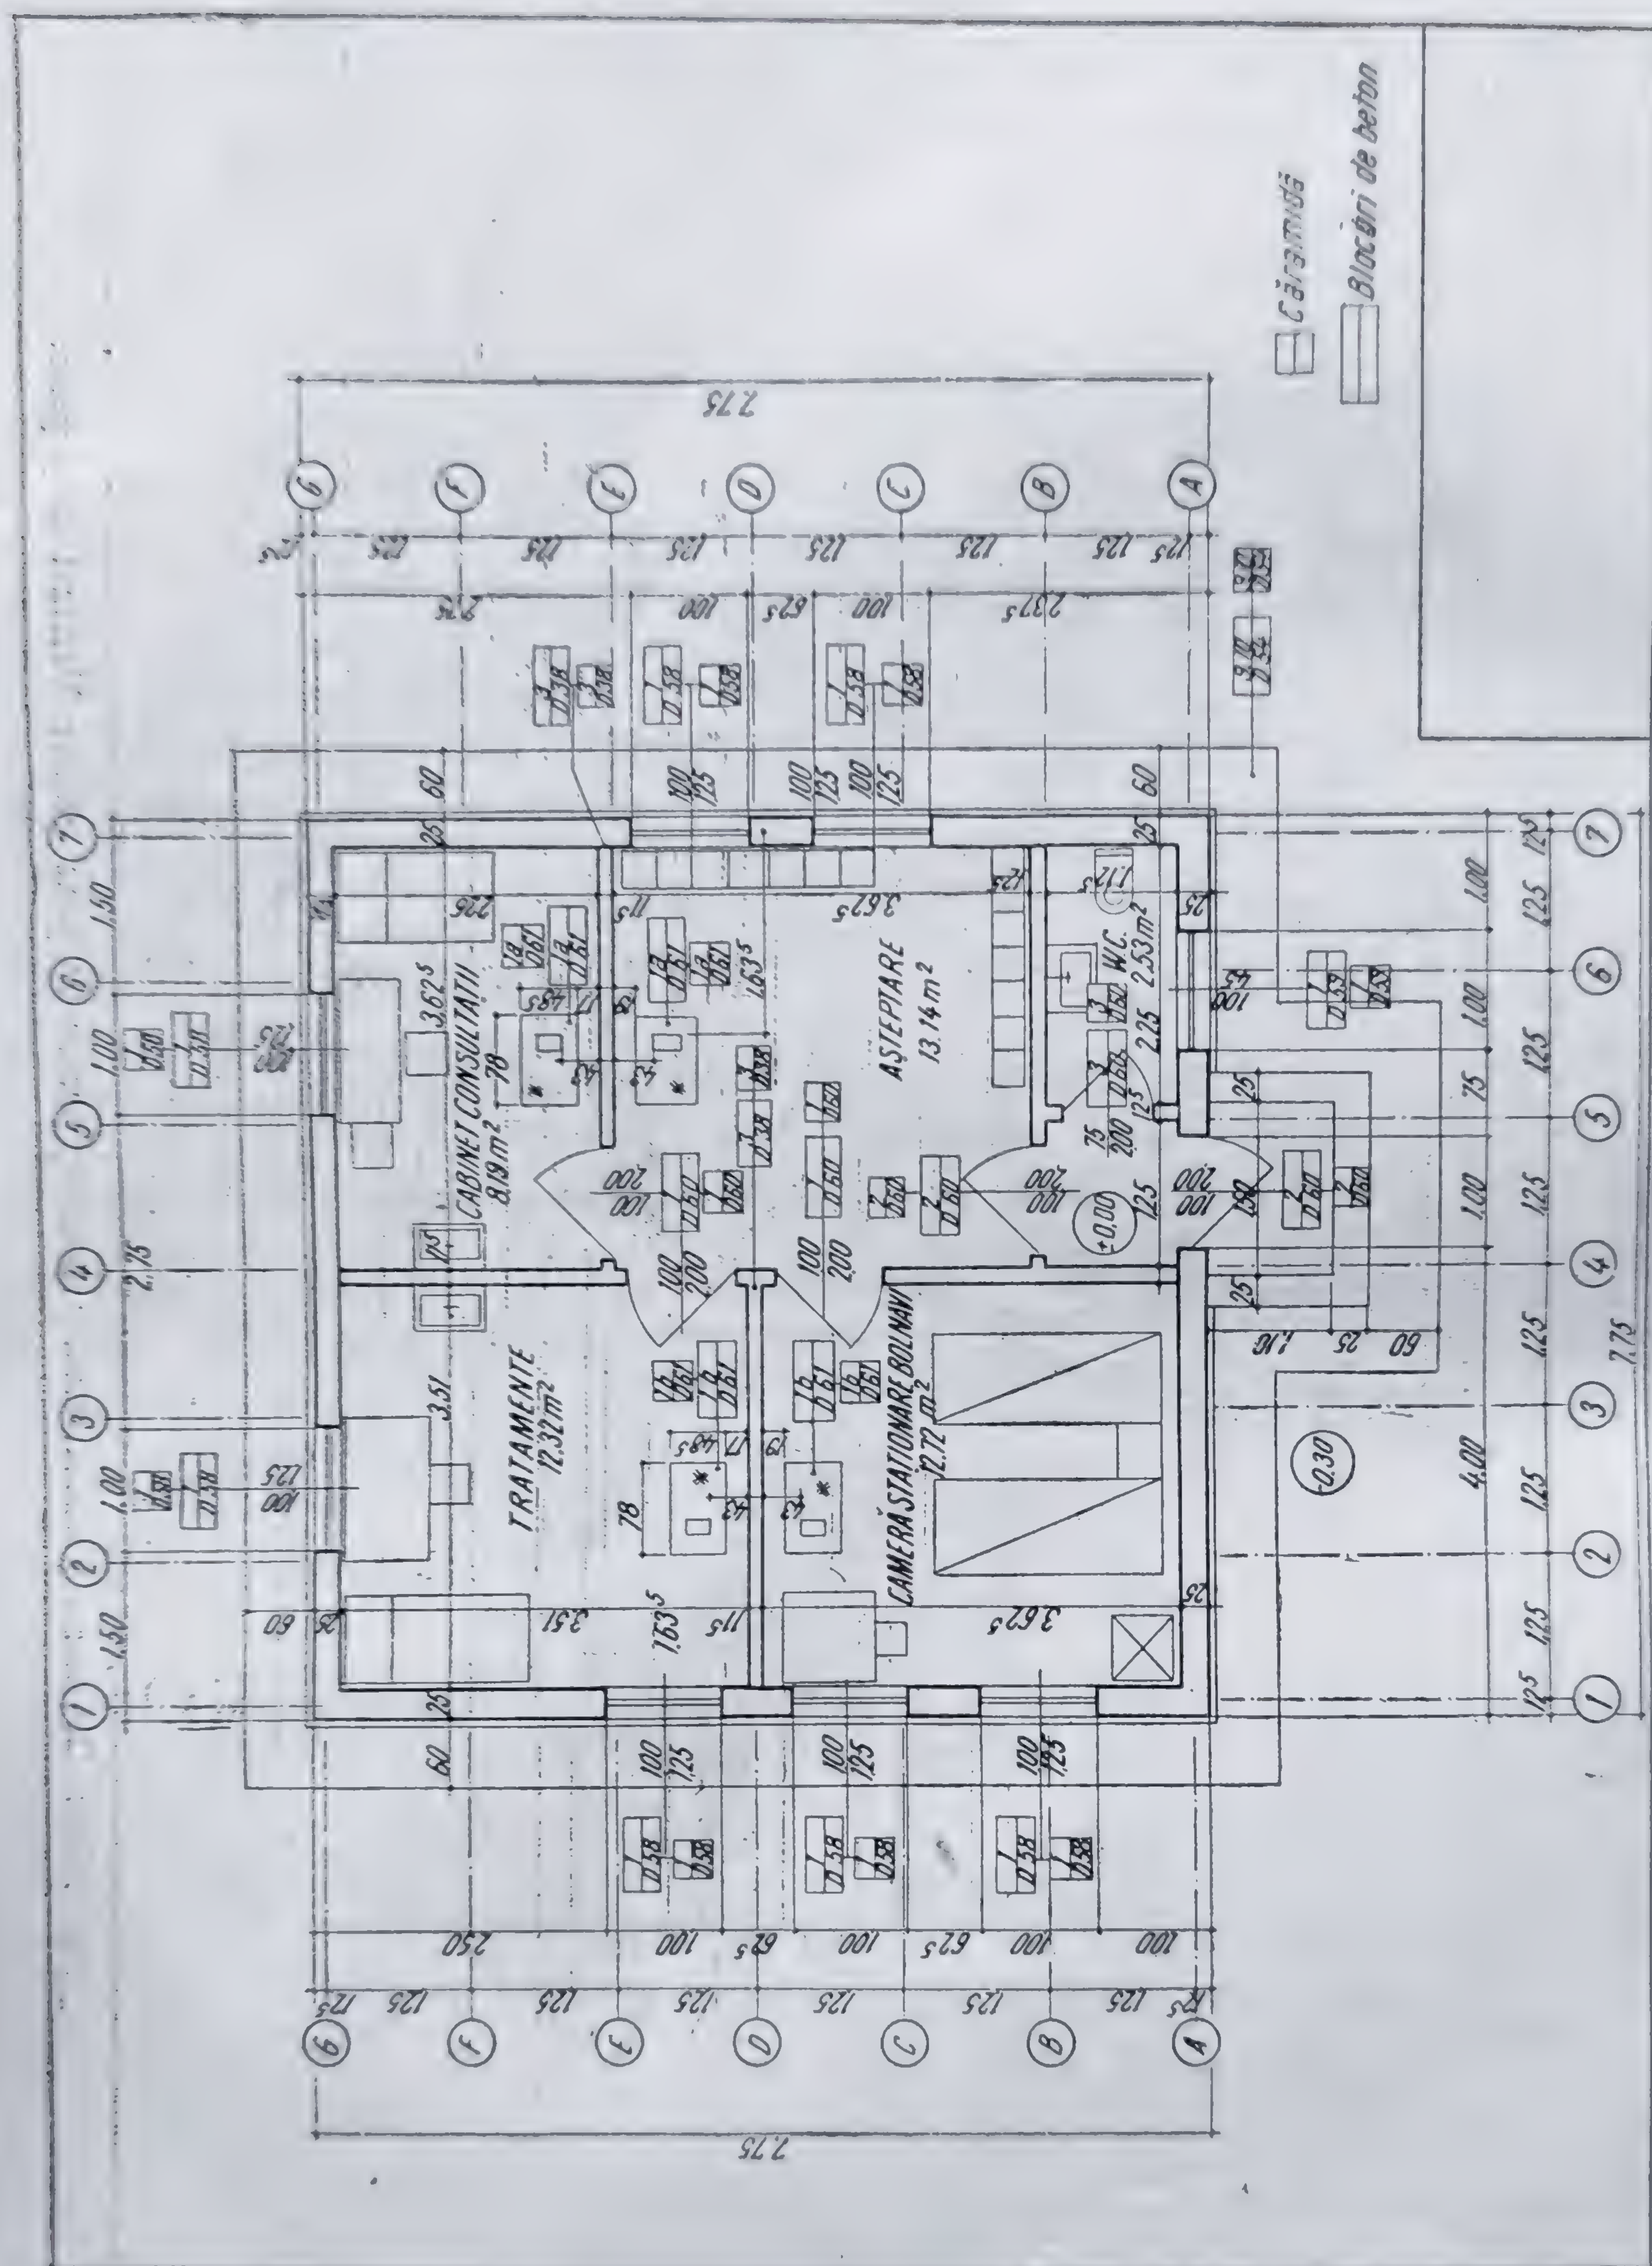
b. Desenarea planului unui proiect pentru un punct sanitar. Varianta cărămidă și blocuri de beton.
